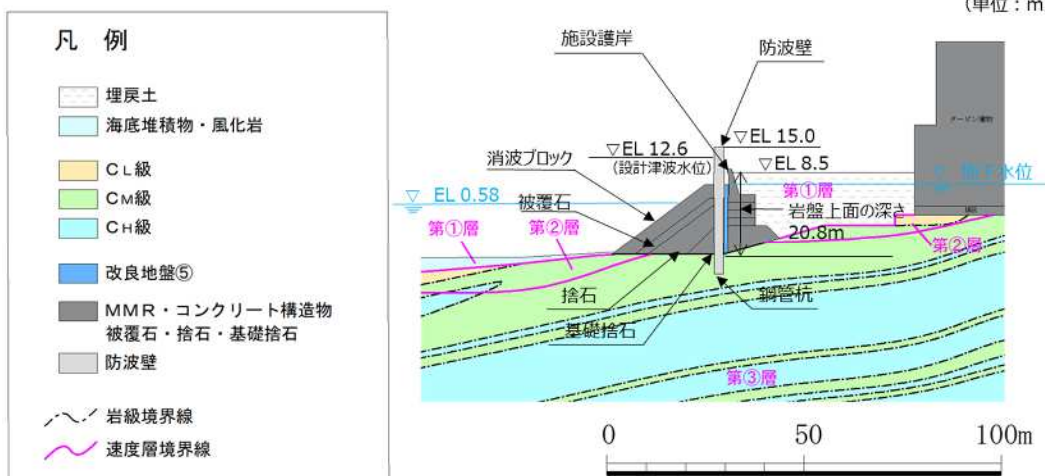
防波壁（多重鋼管杭式擁壁）の横断面図施設護岸前出し部（③-③断面）
